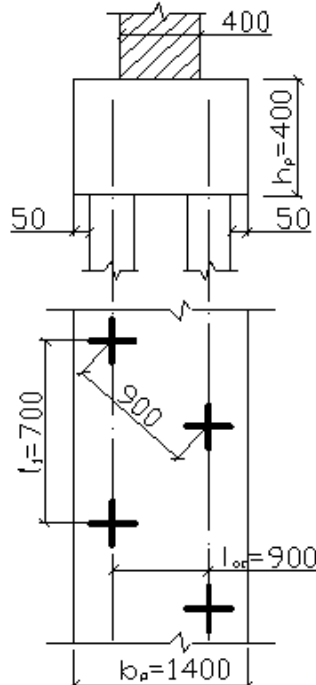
До розрахунку пального фундаменту в 2 – му перерізі
